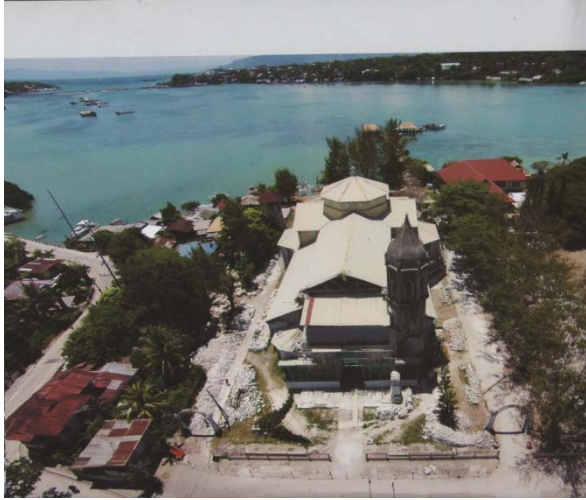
a1 Daus: vista dalla piazza, durante i lavori di restauro
